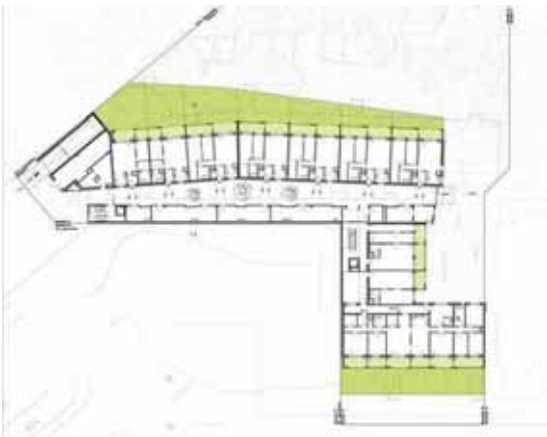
Grundriss (Quelle: s&s architekten)
